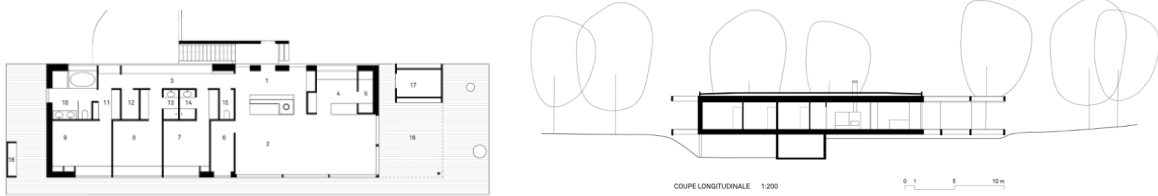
Plan du rez-de-chaussée, coupe, © KARAWITZ
